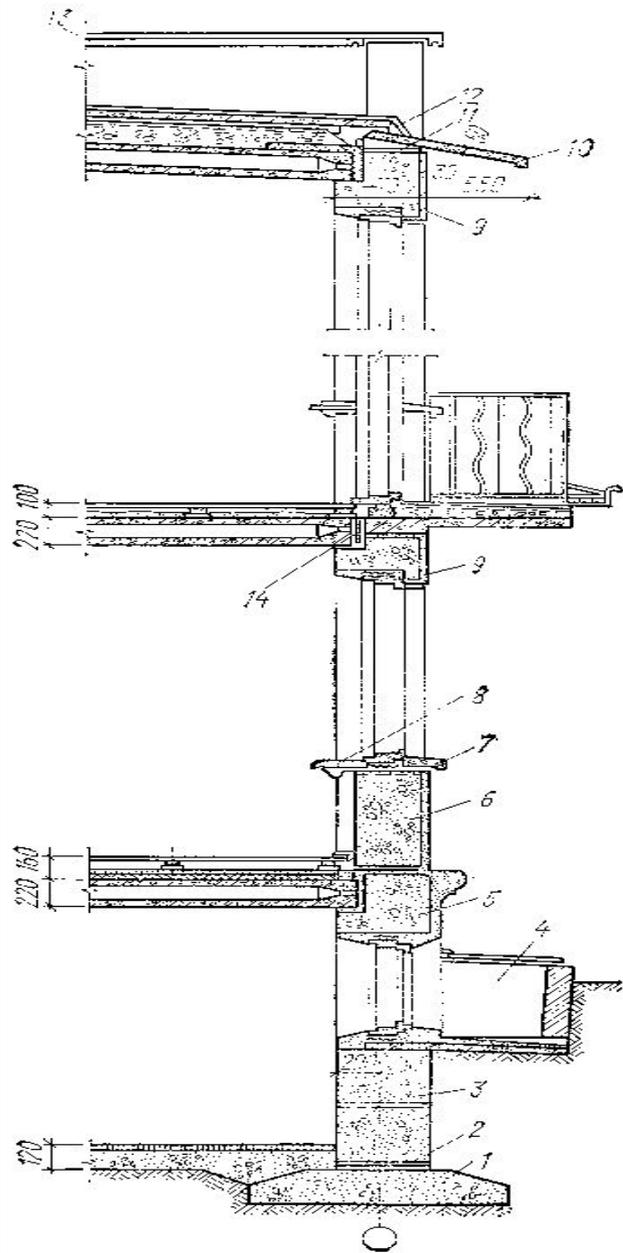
Поперечный разрез наружной стены жилого дома, выполненный из легкобетонных крупных блоков:
